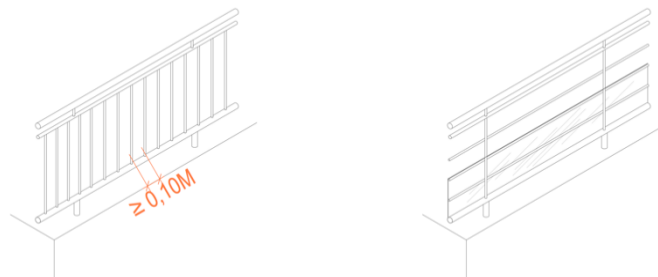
Géométrie des garde-corps - entraxe entre barreaux verticaux et dispositifs empêchant de grimper
